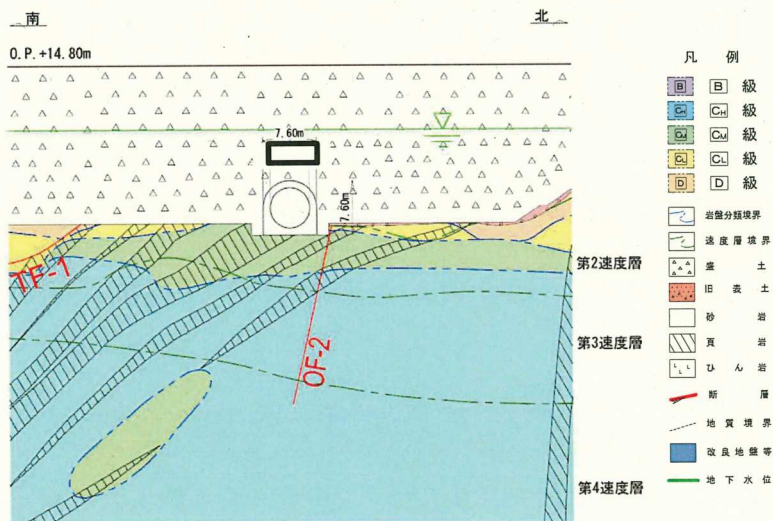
排気筒連絡ダクト (土砂部) 地質断面図 (断面①)
